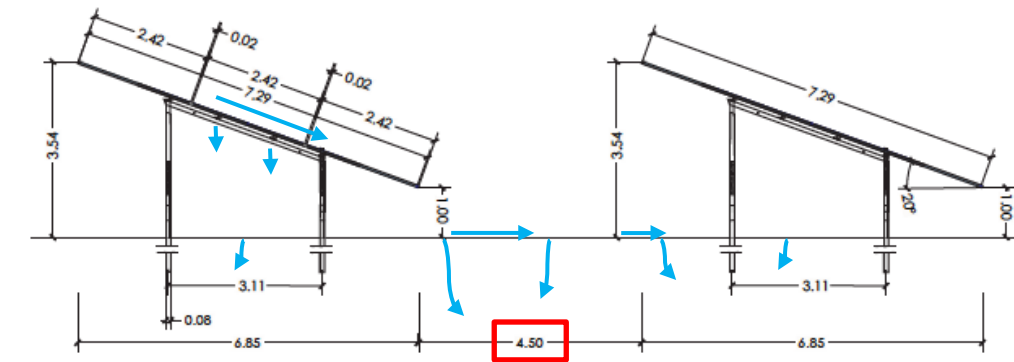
Plan projet Carrières (source : dossier de demande de permis de construire, Enertrag)
